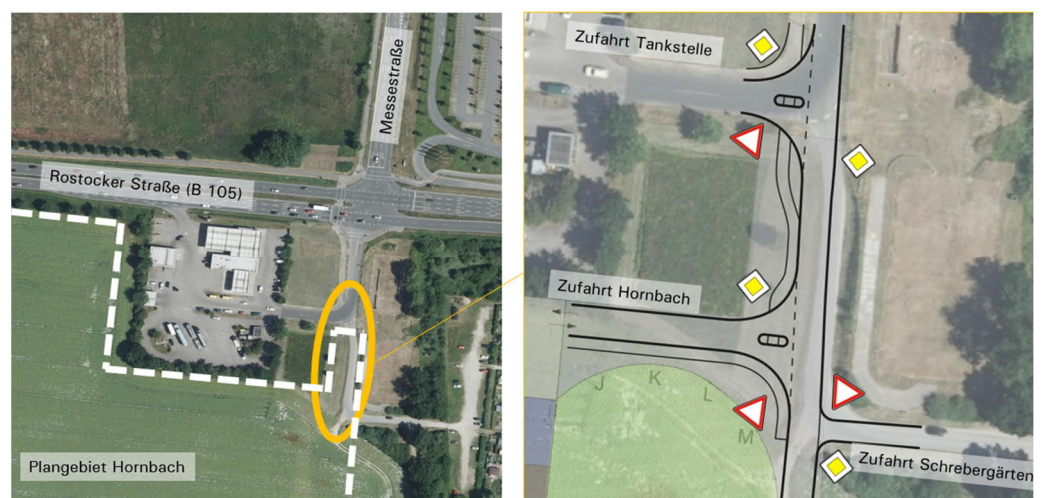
Lageplandarstellung der östlichen Anbindung des Hornbach-Marktes
